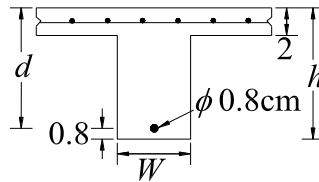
Detalle del refuerzo para ambas losas encasetonadas
